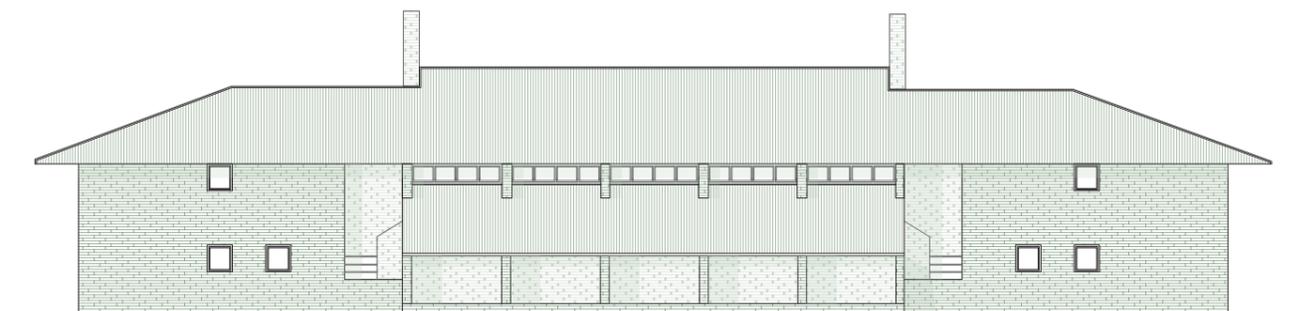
Alzado norte, Casa Añón. Escala 1:250. Elaboración propia.
